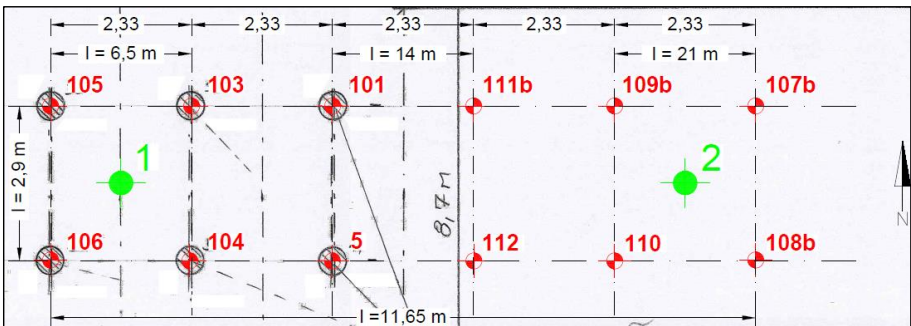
Lageplan Drucksondierungen Testfeld 1 – Bremerhaven
